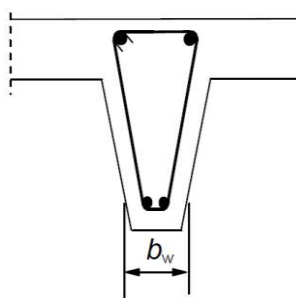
Modelo de estribo para a zona aligeirada [2]
